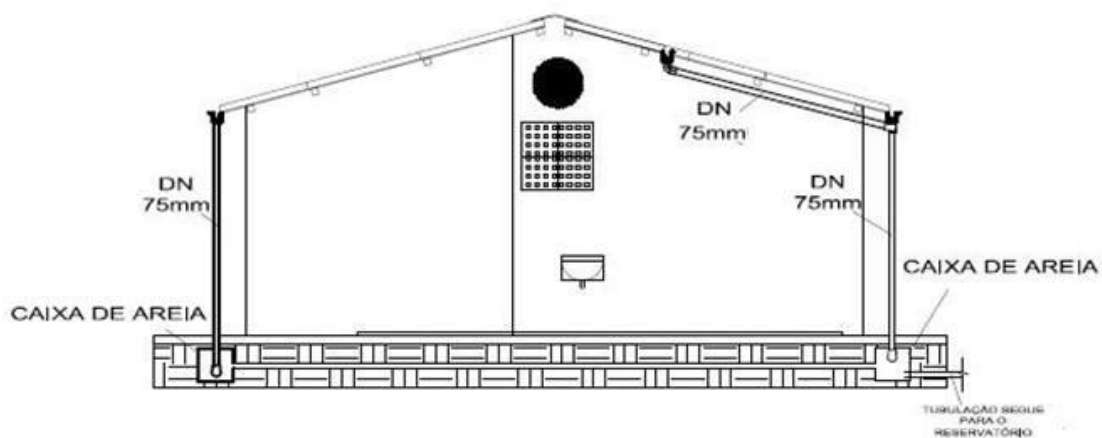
Detalhe condutores horizontais, verticais de caixas de areia.
